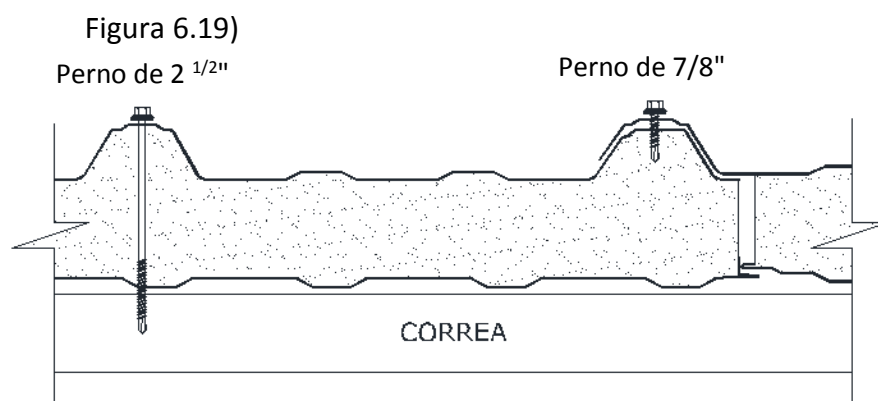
Fijación del panel a la estructura de cubierta (Fuente: METCOL)
